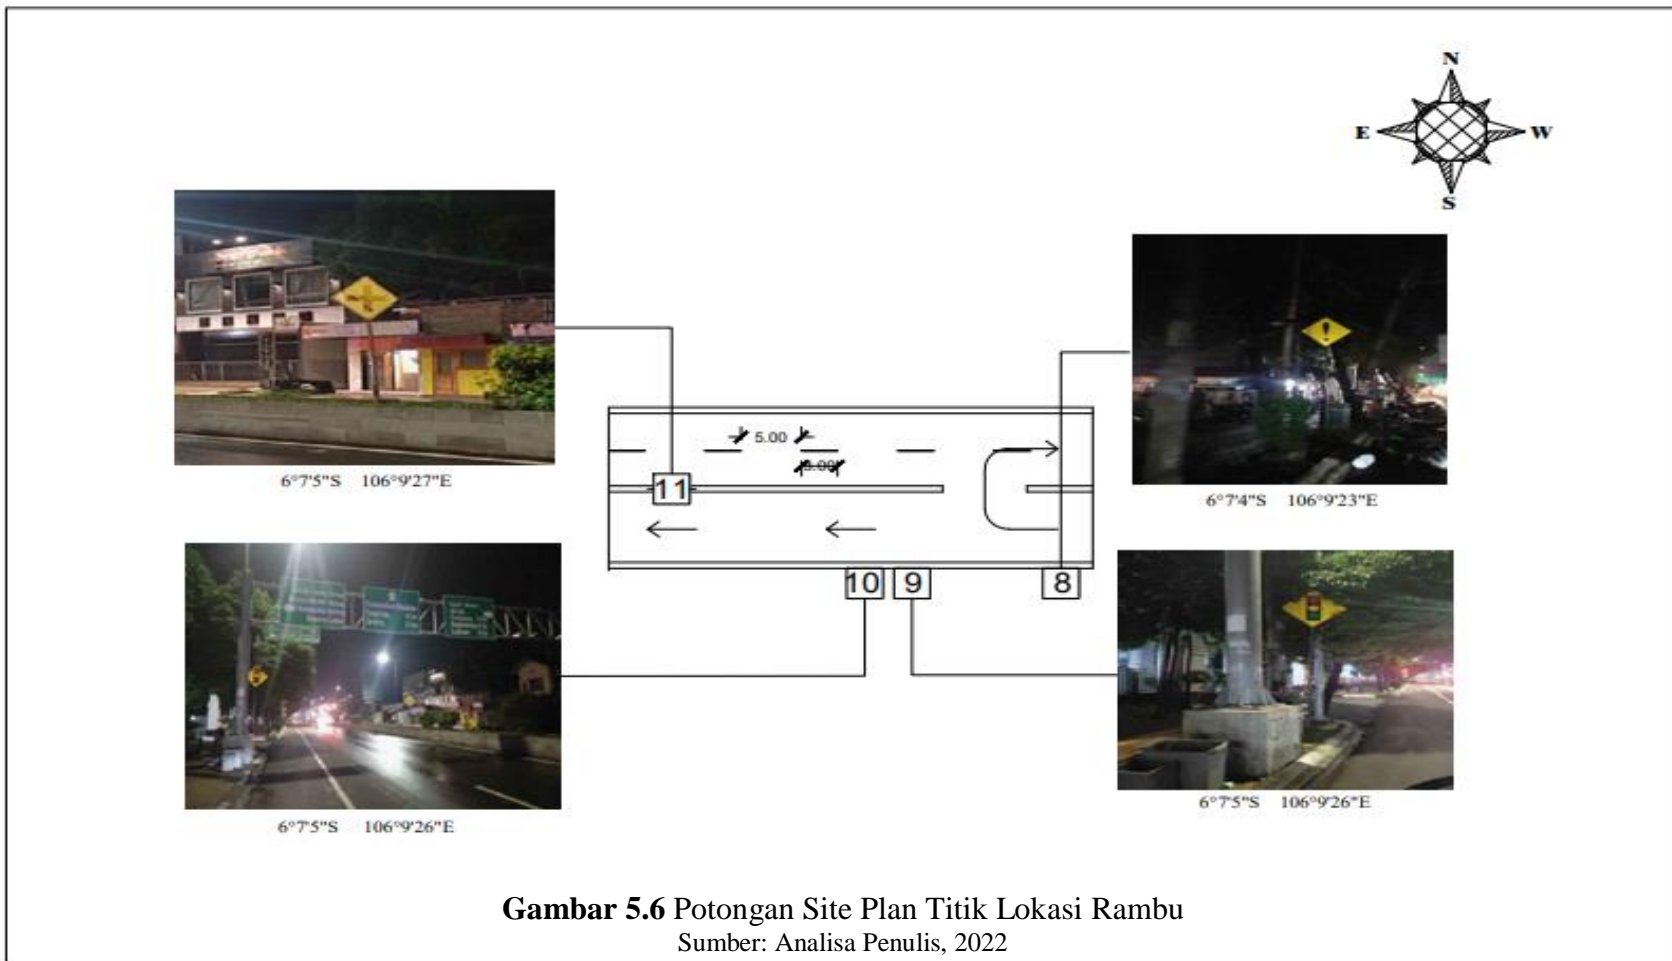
Potongan Site Plan Titik Lokasi Rambu
